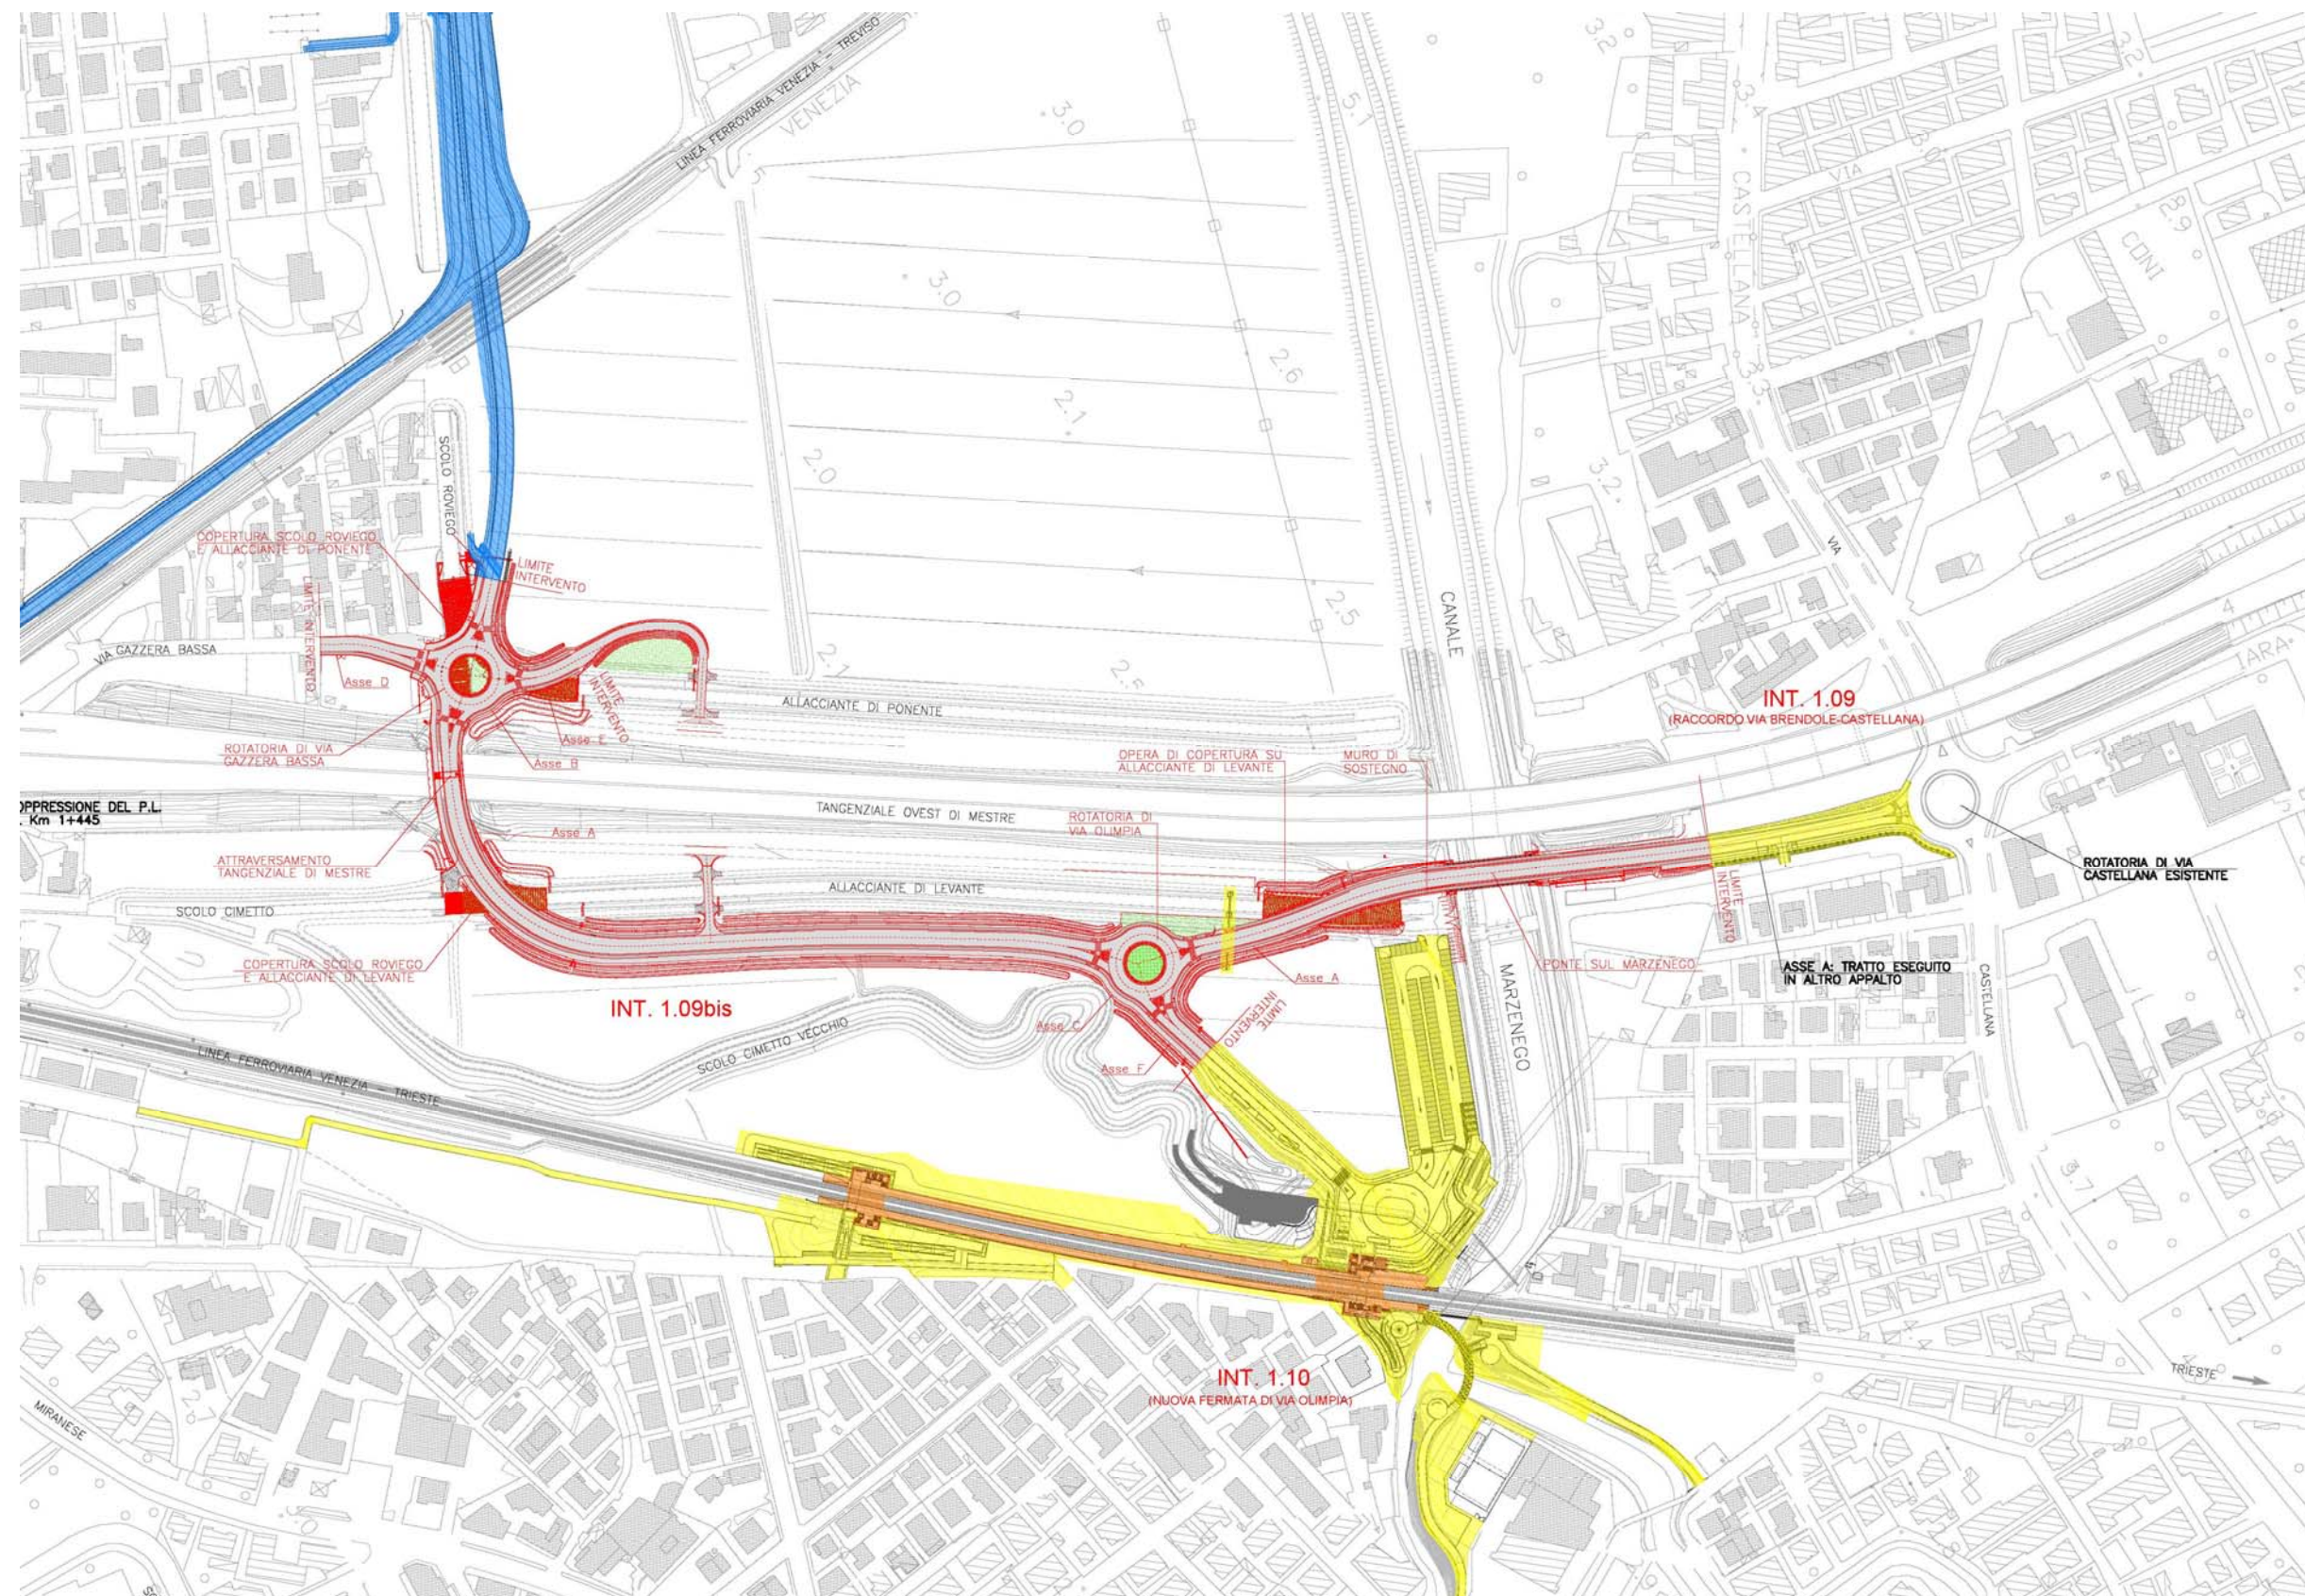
Intervento 1.09bis – Planimetria di progetto
